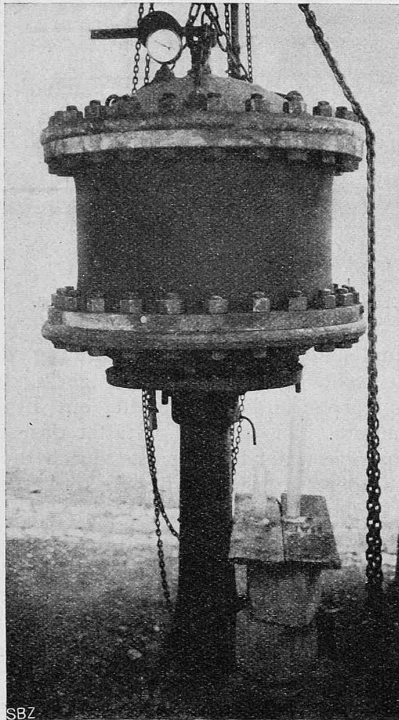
Druckzylinder aus Eisenbeton, im Bau.
